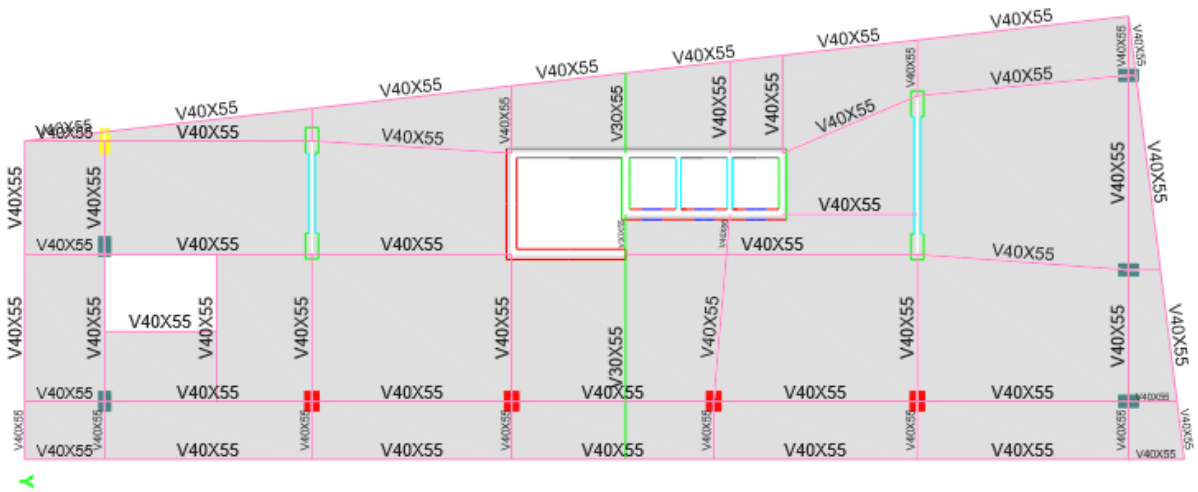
Planta Tipo N+31.12 a N+40.84
